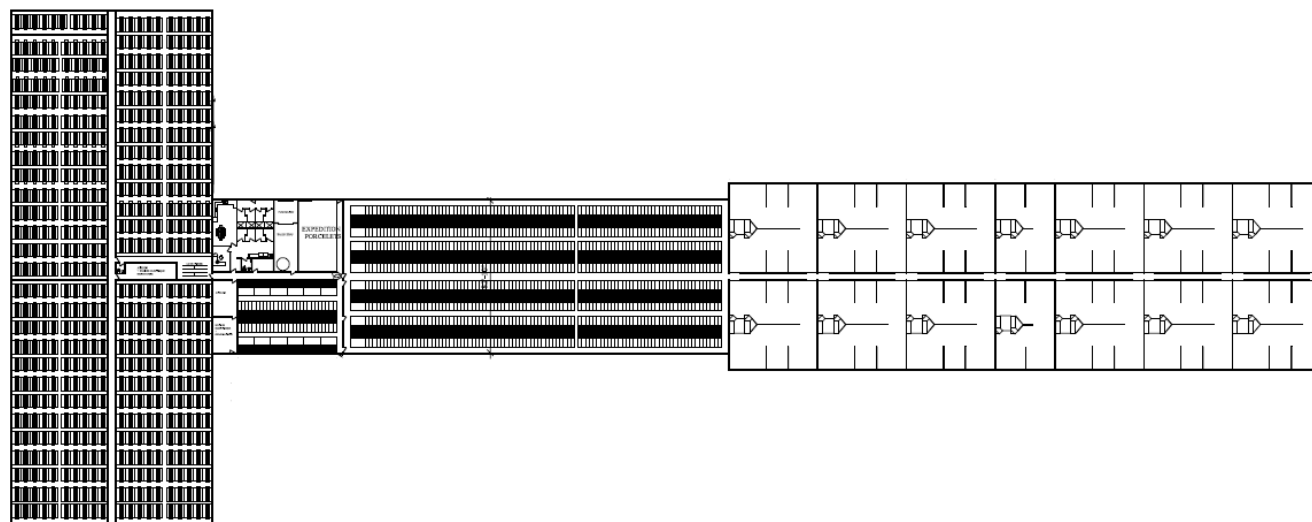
Plan de la maternité de 2 400 truies en groupe avec DAC
